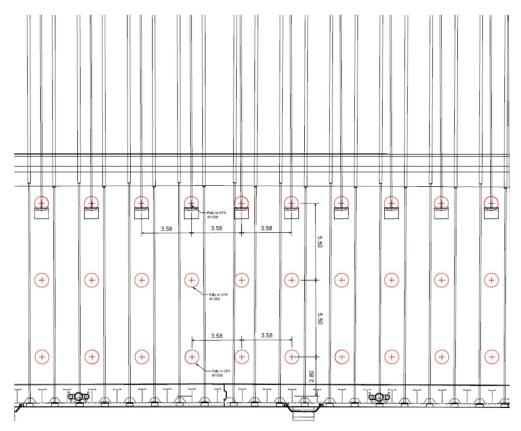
Trattaroli Nord – Progetto Esecutivo Soluzione – Planimetria intervento
